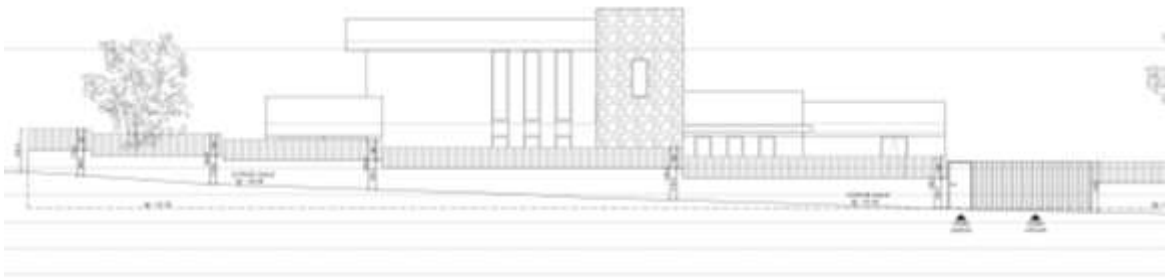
Alzado noreste. Fuente: proyecto básico y de ejecución
